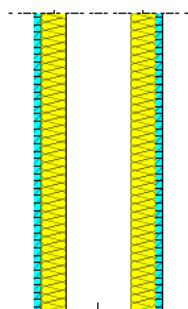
Pormenor da parede interior – Par\_Int\_4.
